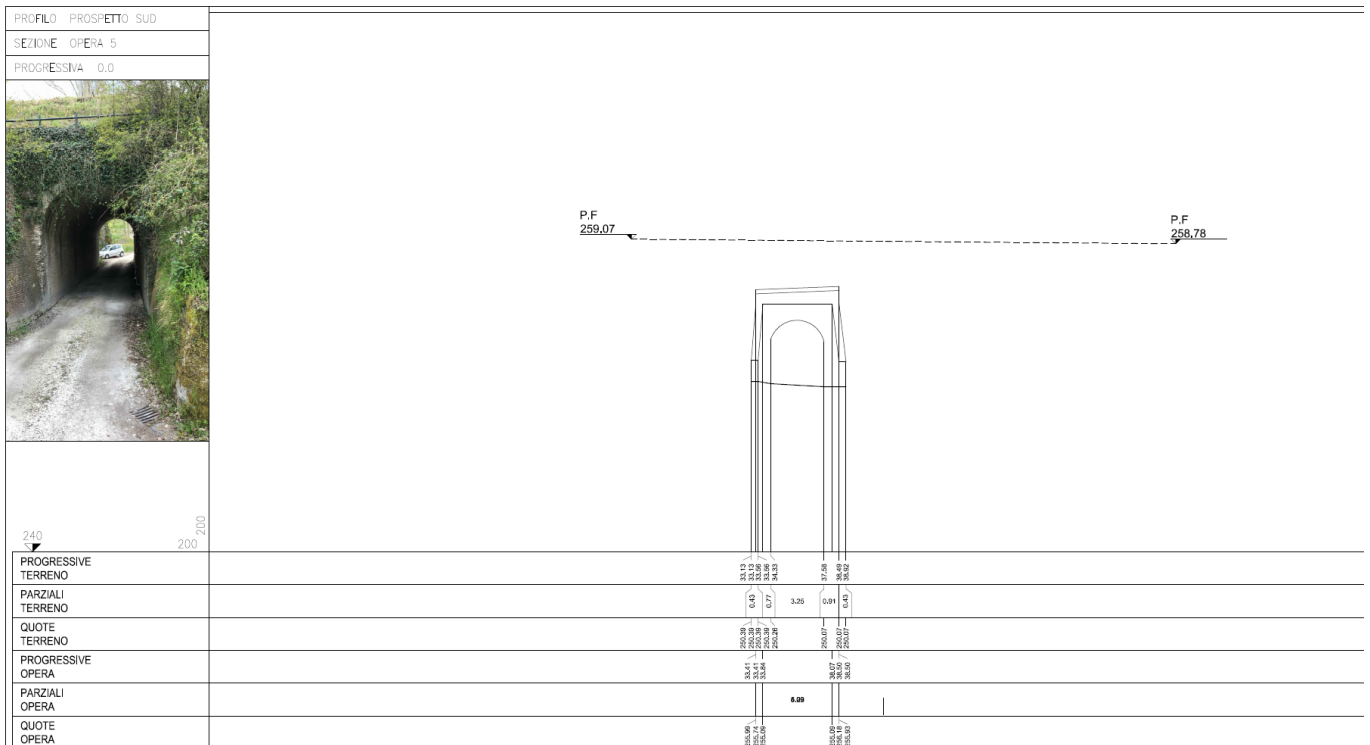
S4 – Profilo sottopasso Prospetto sud
